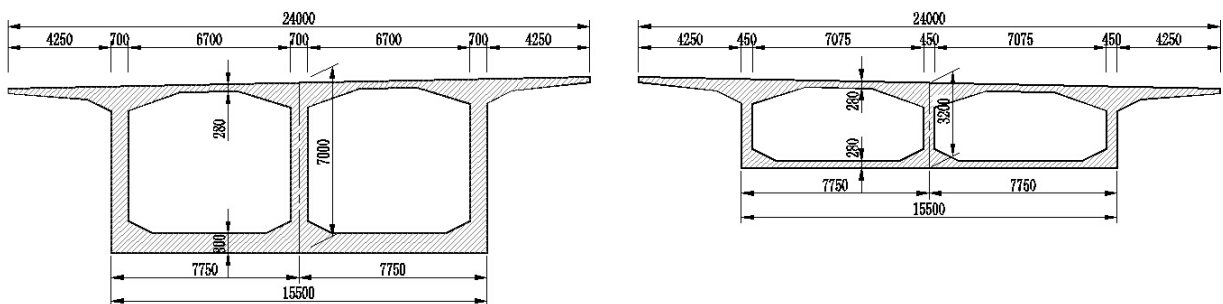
主桥箱梁结构断面 (单位: mm)
